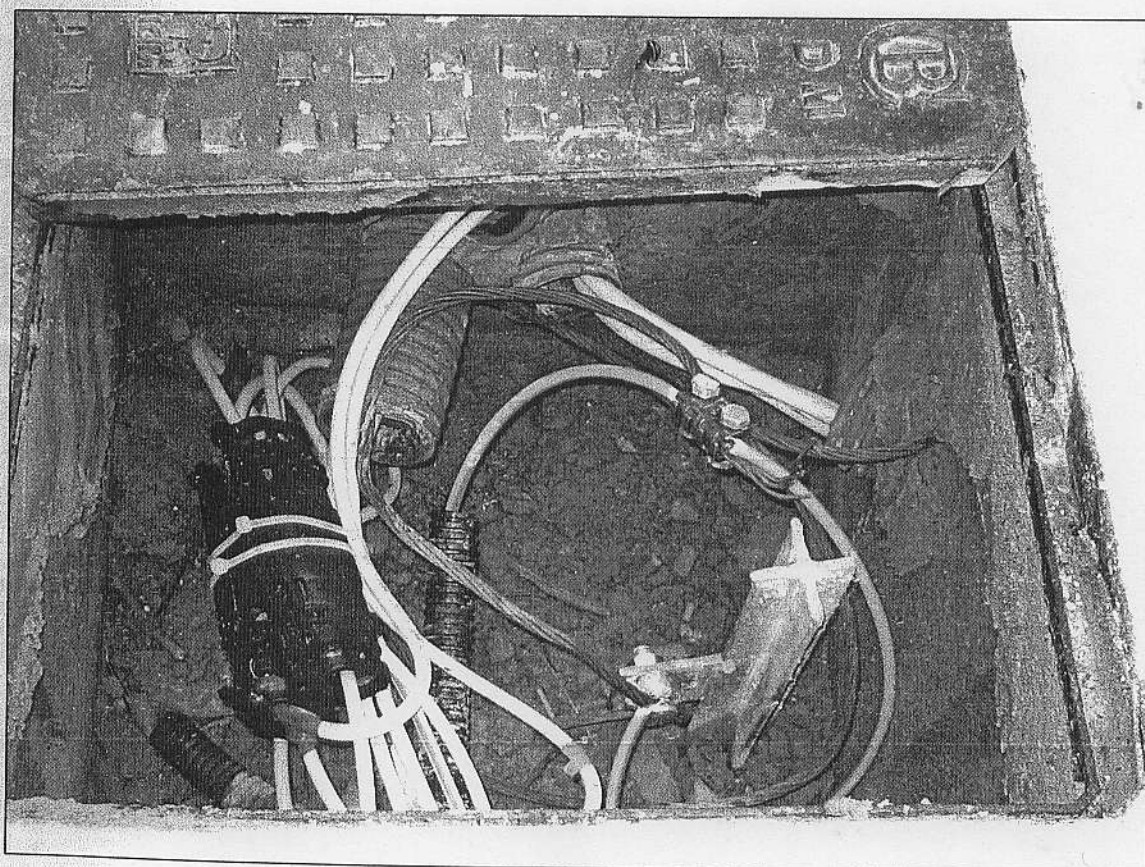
Pozzetto in dotazione al palo ubicato in prossimità della villetta n. 6, nel quale trovano collocazione i dispositivi elettrici
